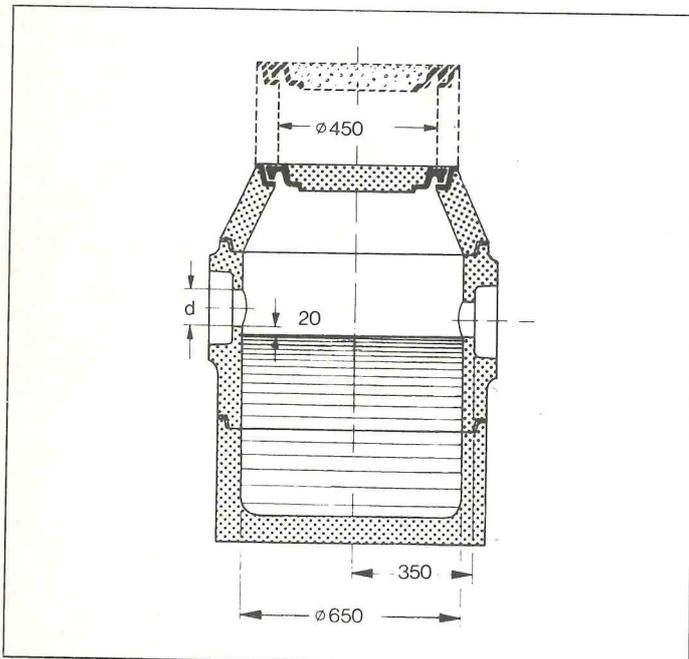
Schlammfang aus Betonfertigteilen für Fettabscheider (Passavant-Werke)
